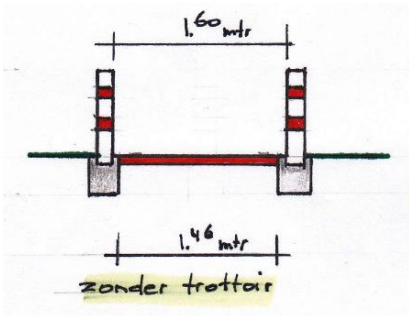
Detaillering van de markering bij een doorgangsbreedte van 1,6 meter
